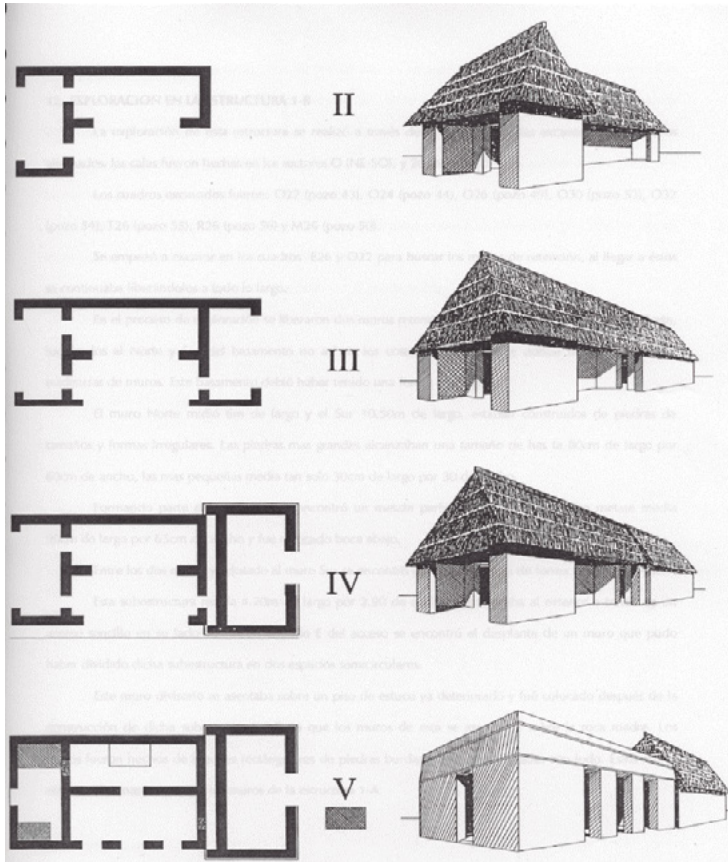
Reconstrucción arquitectónica hipotética de la estructura 1-A.
